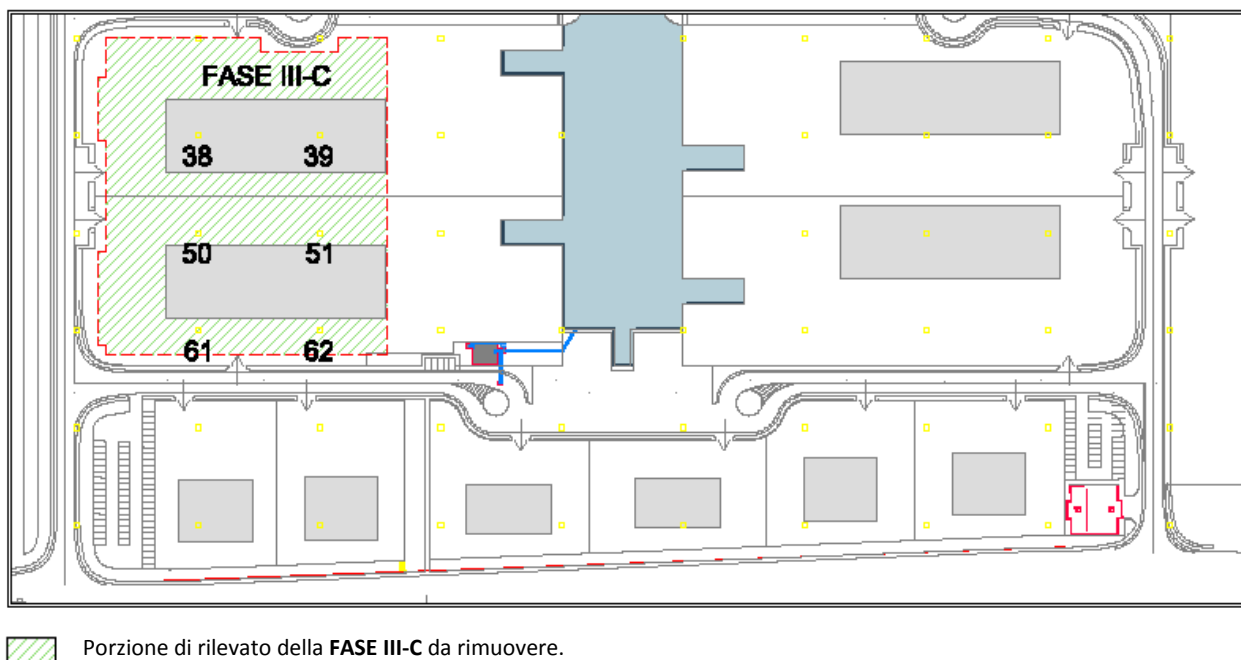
Planimetria delle stazioni di monitoraggio di FASE III.
